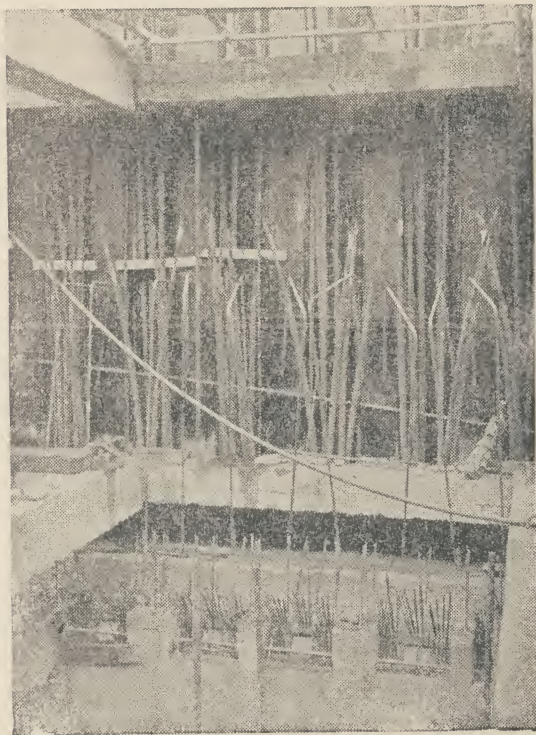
Razuporna konstrukcija od prefabriciranih željezobetonskih elemenata
